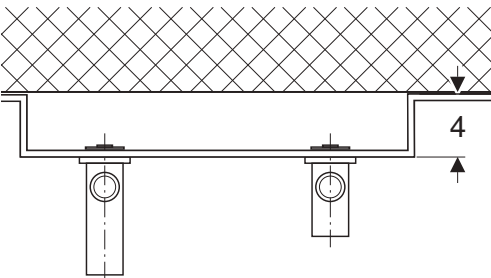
Dimensões de montagem para montagem exterior com a placa de montagem Geberit
